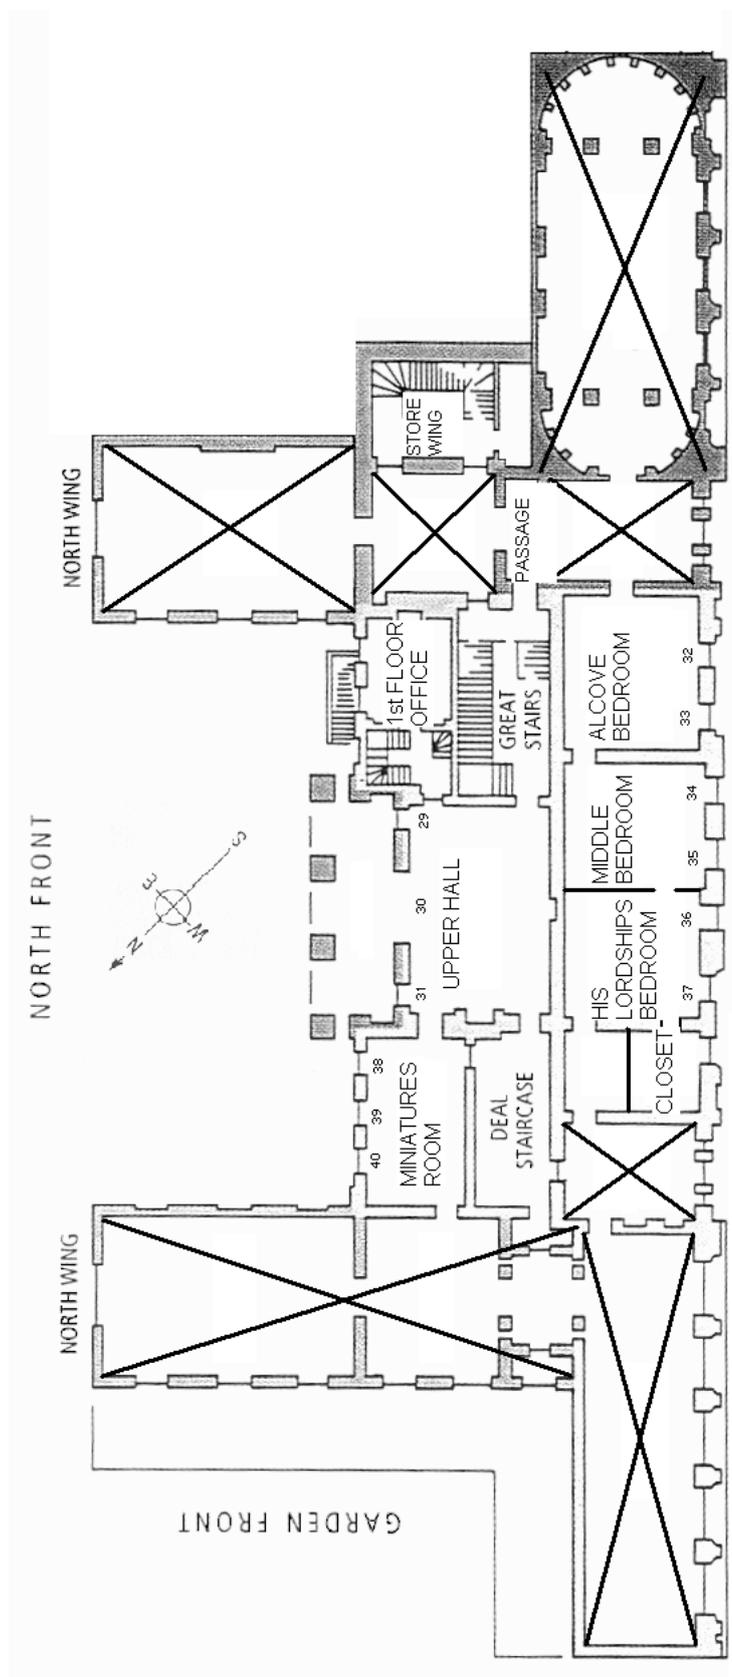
Planta de Ranger's House, rés-do-chão, com os pontos de medição para o plano de luz.
